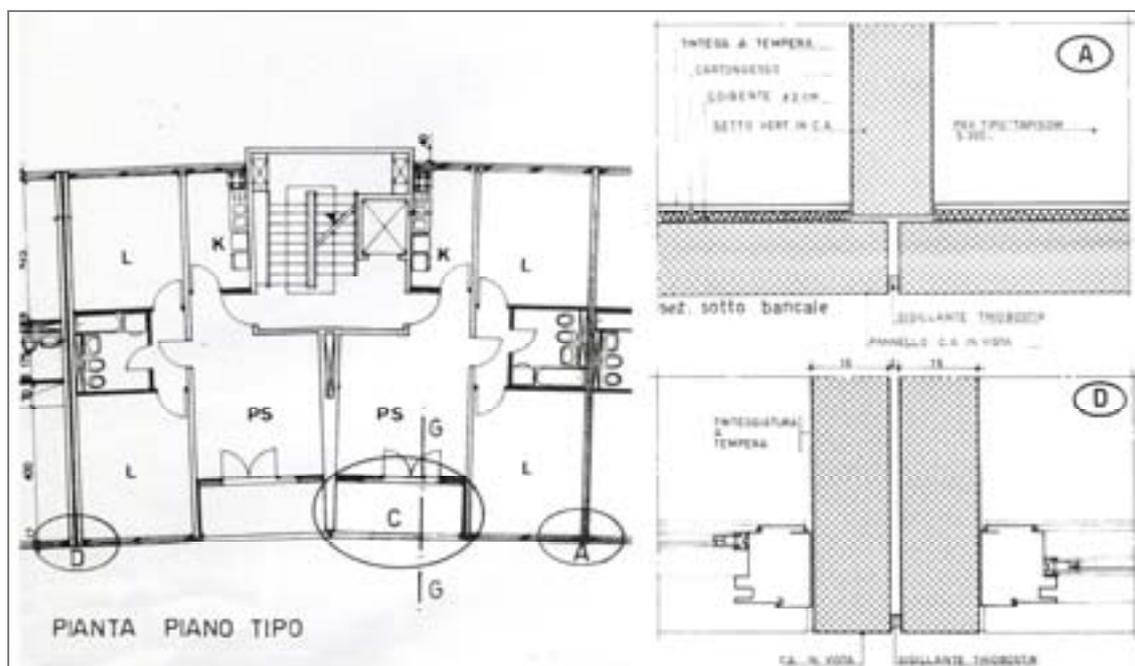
Porzione di pianta del Virgolone, sezioni di dettaglio sotto il bancale e sull'infisso. Archivio Acer Bologna.
